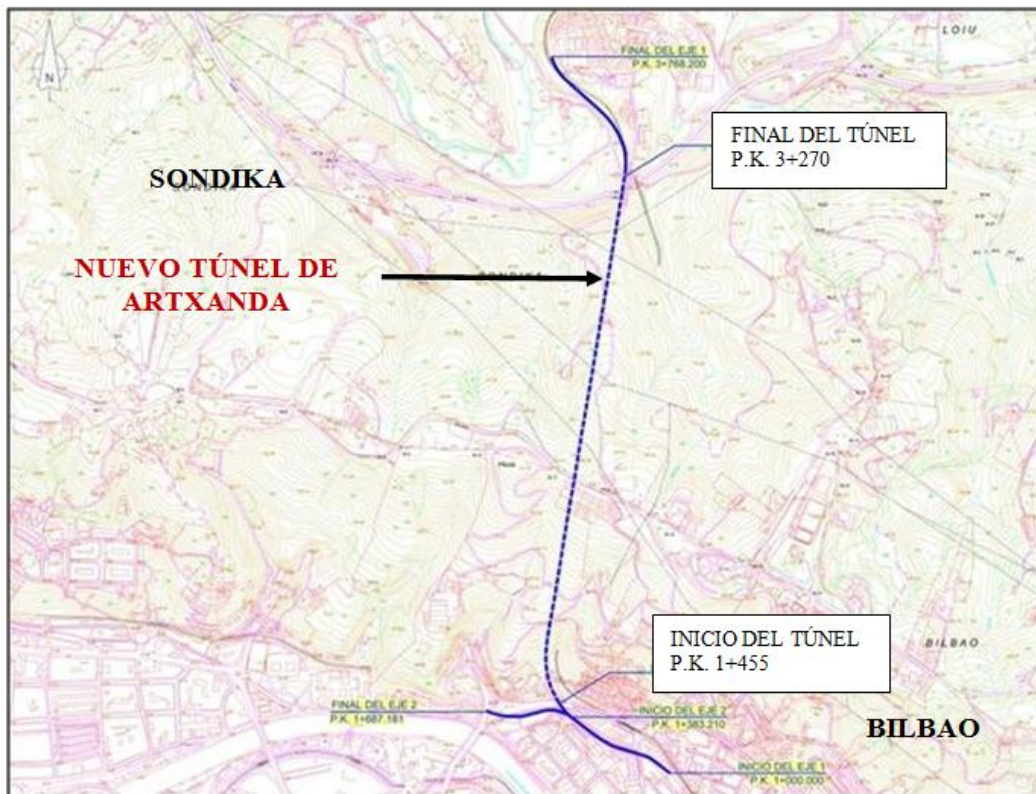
Trazado de la planta del túnel. Fuente: Proyecto de Construcción del Túnel de Artxanda.
